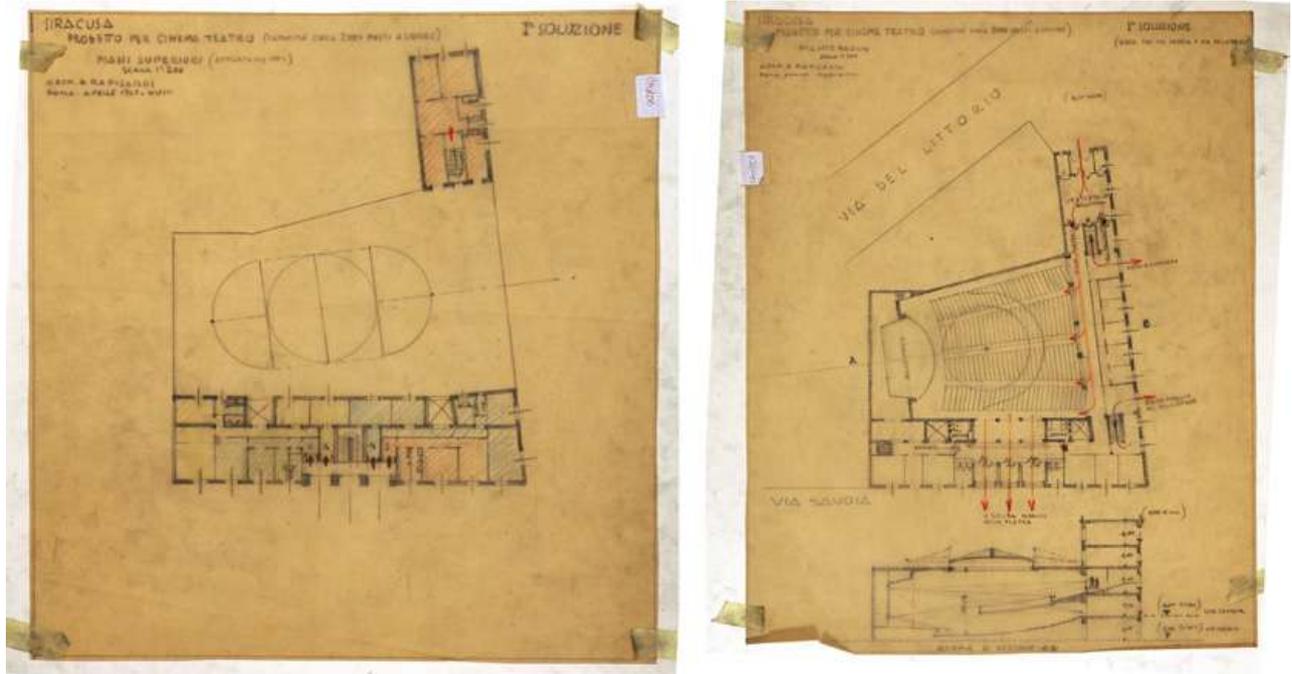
Siracusa, Progetto per cinema teatro dell'architetto Gaetano Rapisardi, 1940 (APR, Archivio Privato Rapisardi).
